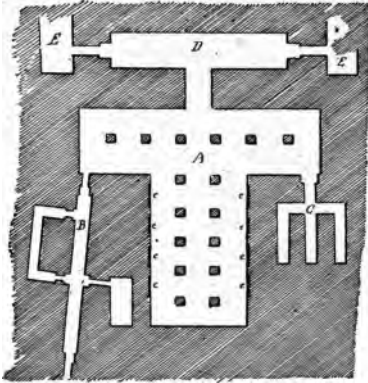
PLAN DU TEMPLE DU SPHINX
